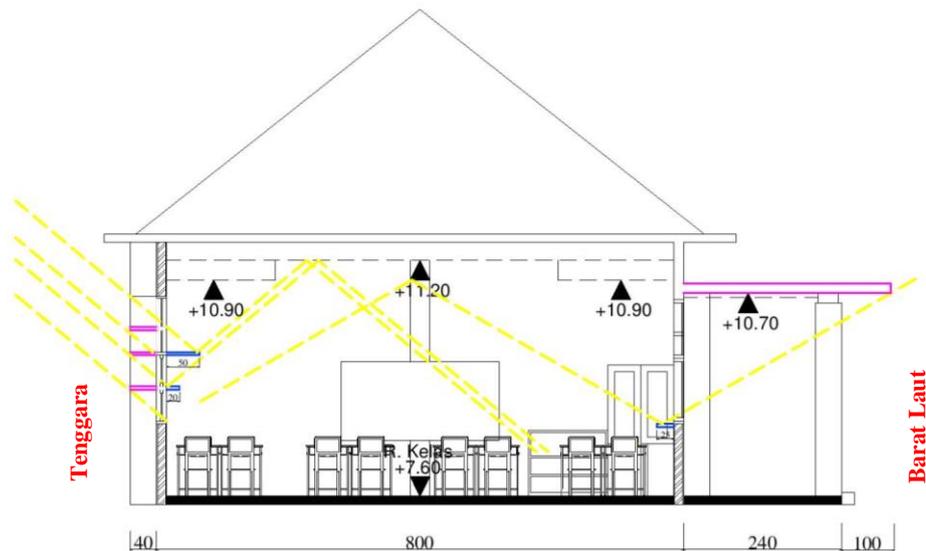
Tampak Tenggara dan Barat Laut Ruang Alternatif 4 Rekomendasi Eksternal-Internal Ruang Kelas IPA
